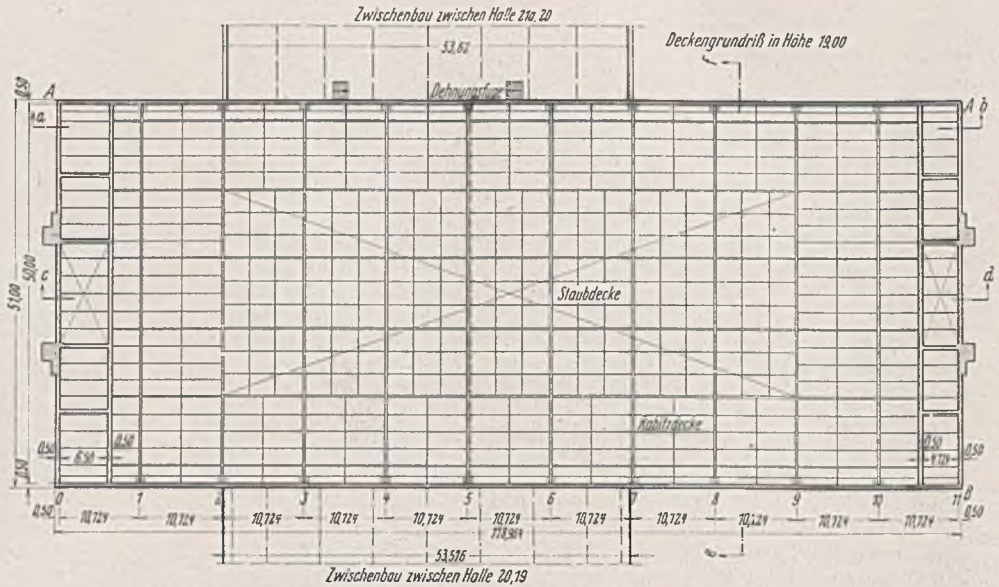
Grundriß der Halle 20 in 19 m Höhe.
